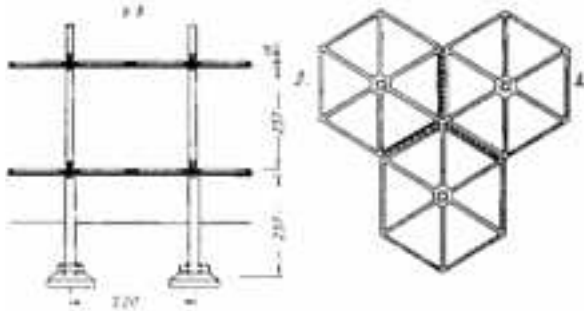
Готель «Тарасова гора». Грибоподібний каркас. Розріз. План фрагменту перекриття.
